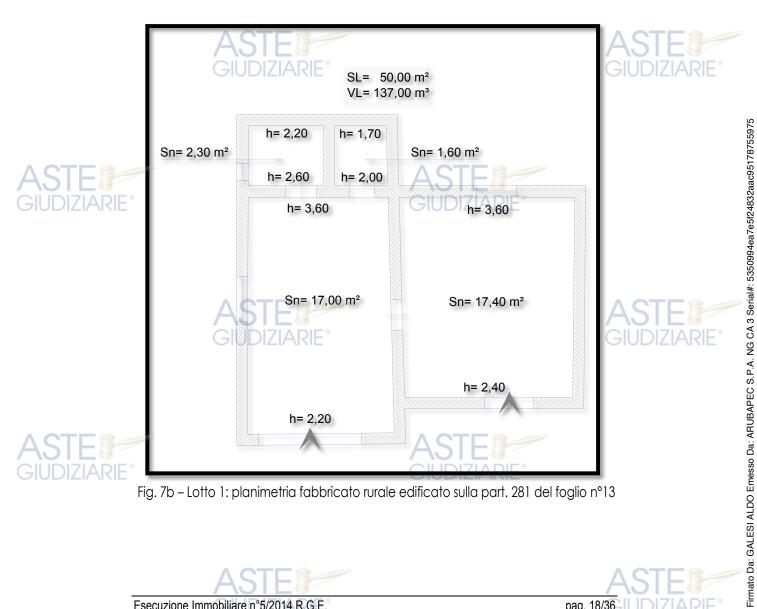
Lotto 1: planimetria fabbricato rurale edificato sulla part. 281 del foglio nº13
